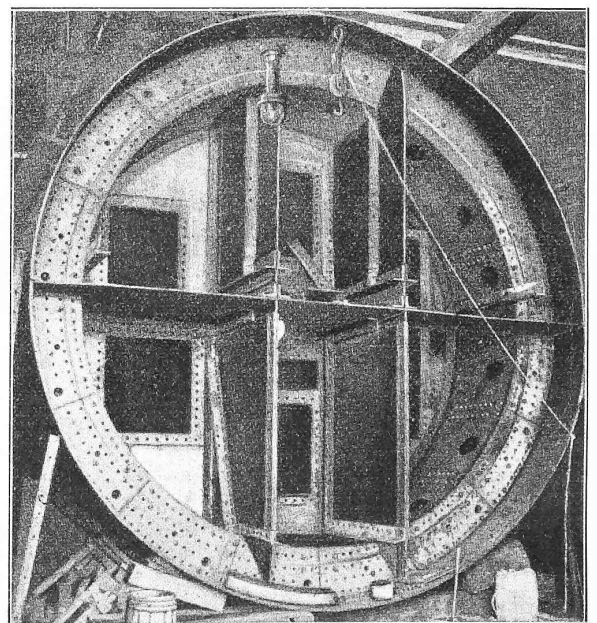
Ansicht des Schildes für den Bau der südlichen Tunnelröhre des Strassenbahntunnels unter dem North River.
